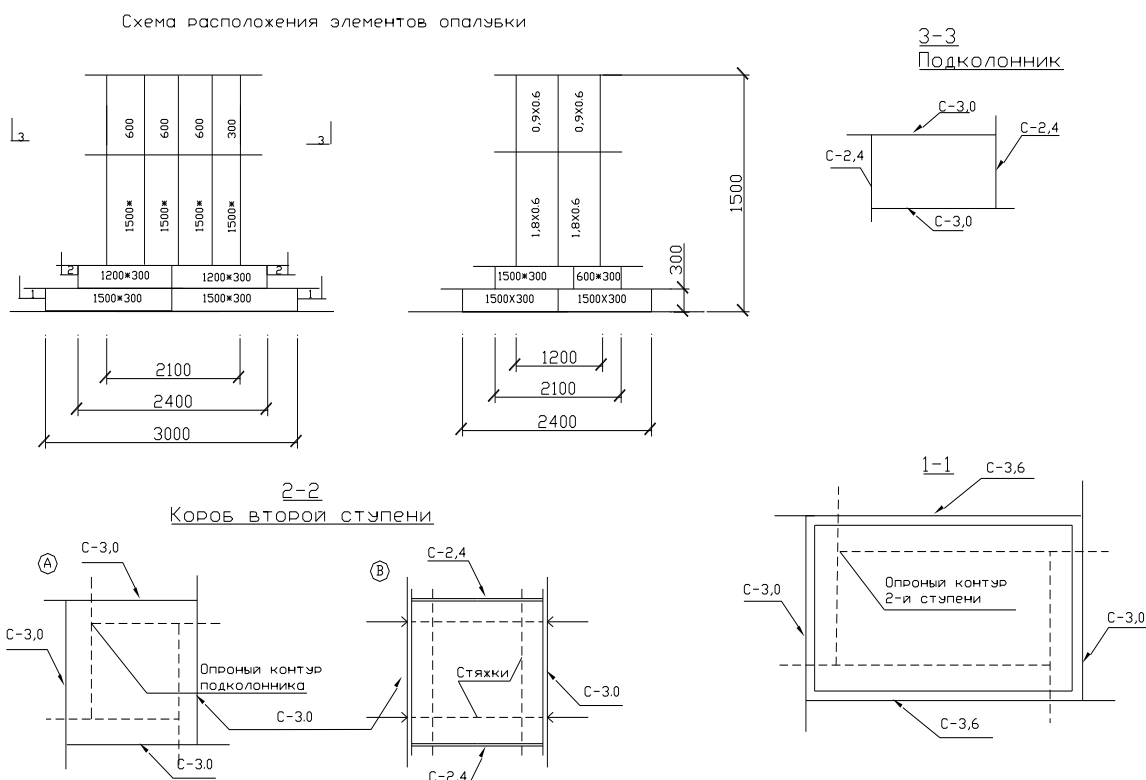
Раскладка щитов и постанова схваток опалубки столбчатого фундамента: А – вариант, когда все панели равны размерам фундамента; Б – вариант, когда две панели равны, а две больше размеров фундамента
